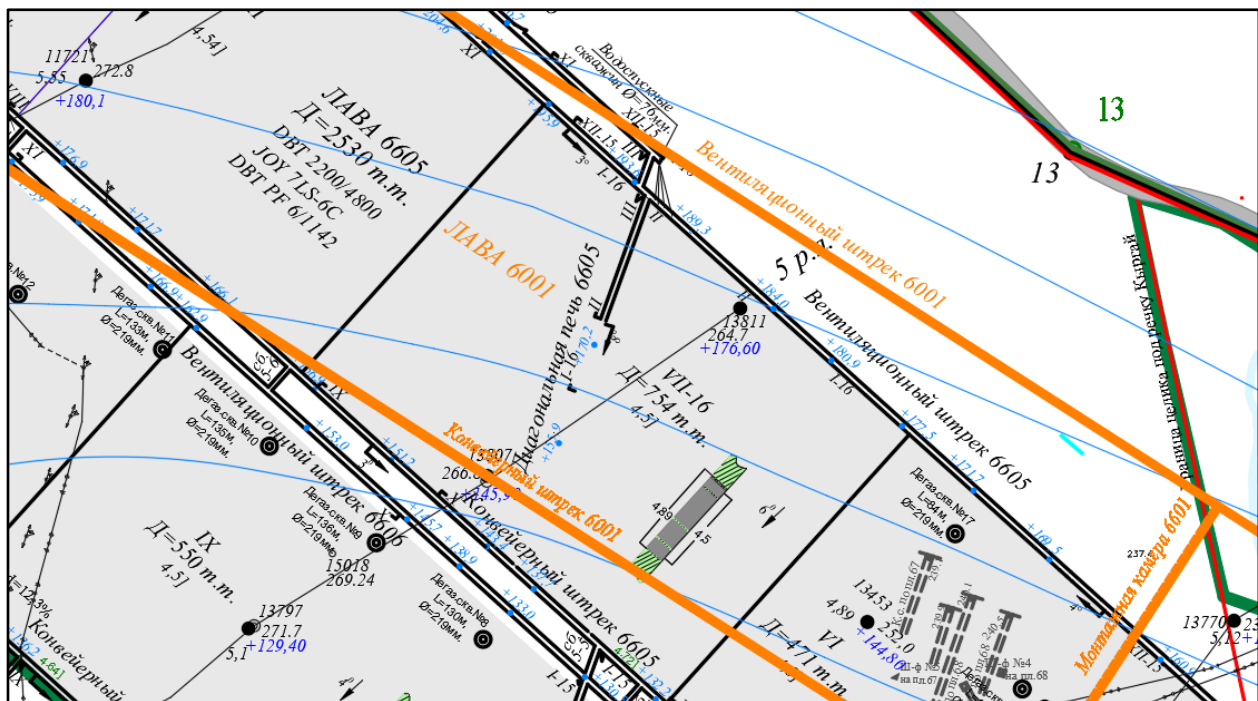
Совмещенный план горных выработок влияющего пласта 6б и планируемого к отработке пласта 60
